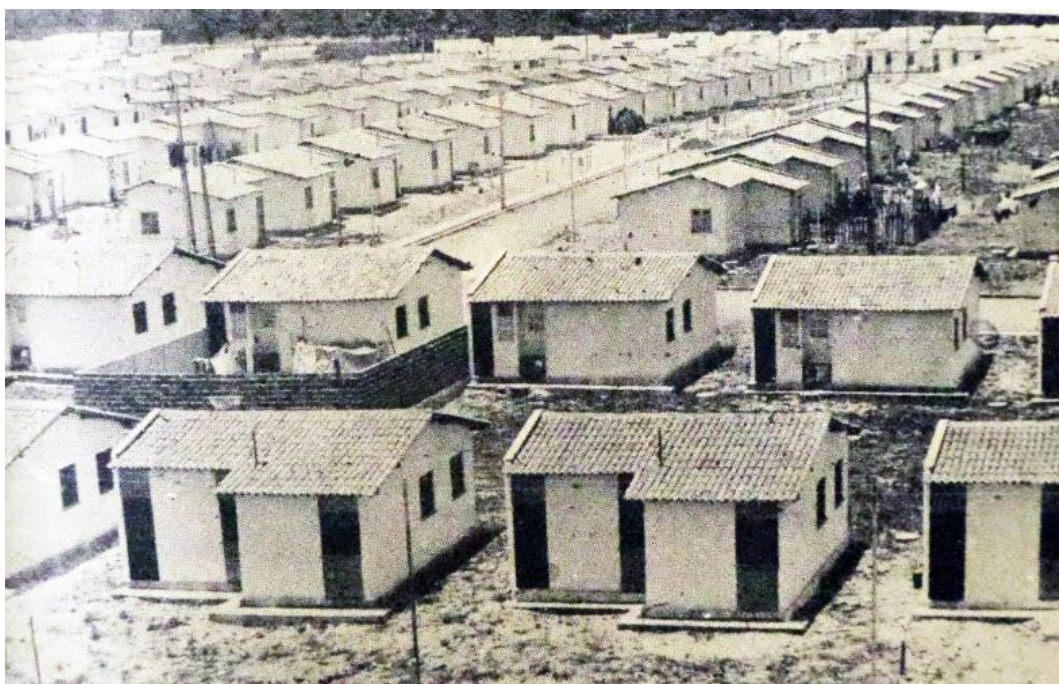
Construção do Conjunto Augusto Franco em 1982.
